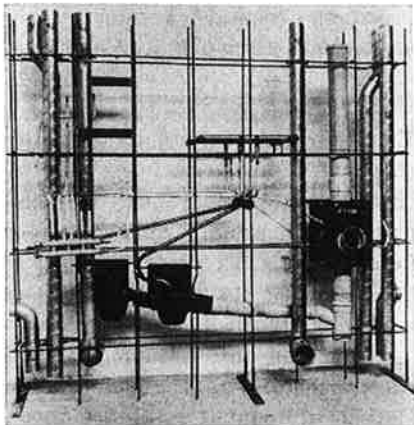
Fabriksstillverkat installationsblock för ingjutning på betongfabrik (AB Gustavsbergs Fabriker).
